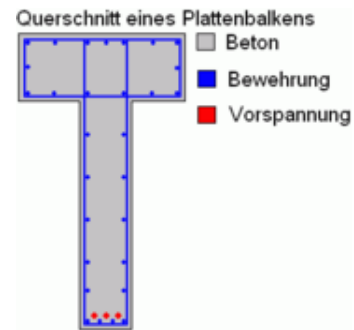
Esquema de la sección transversal de una viga donde se aprecia la armadura pasiva (color azul) y la armadura de pretensado (color rojo).
